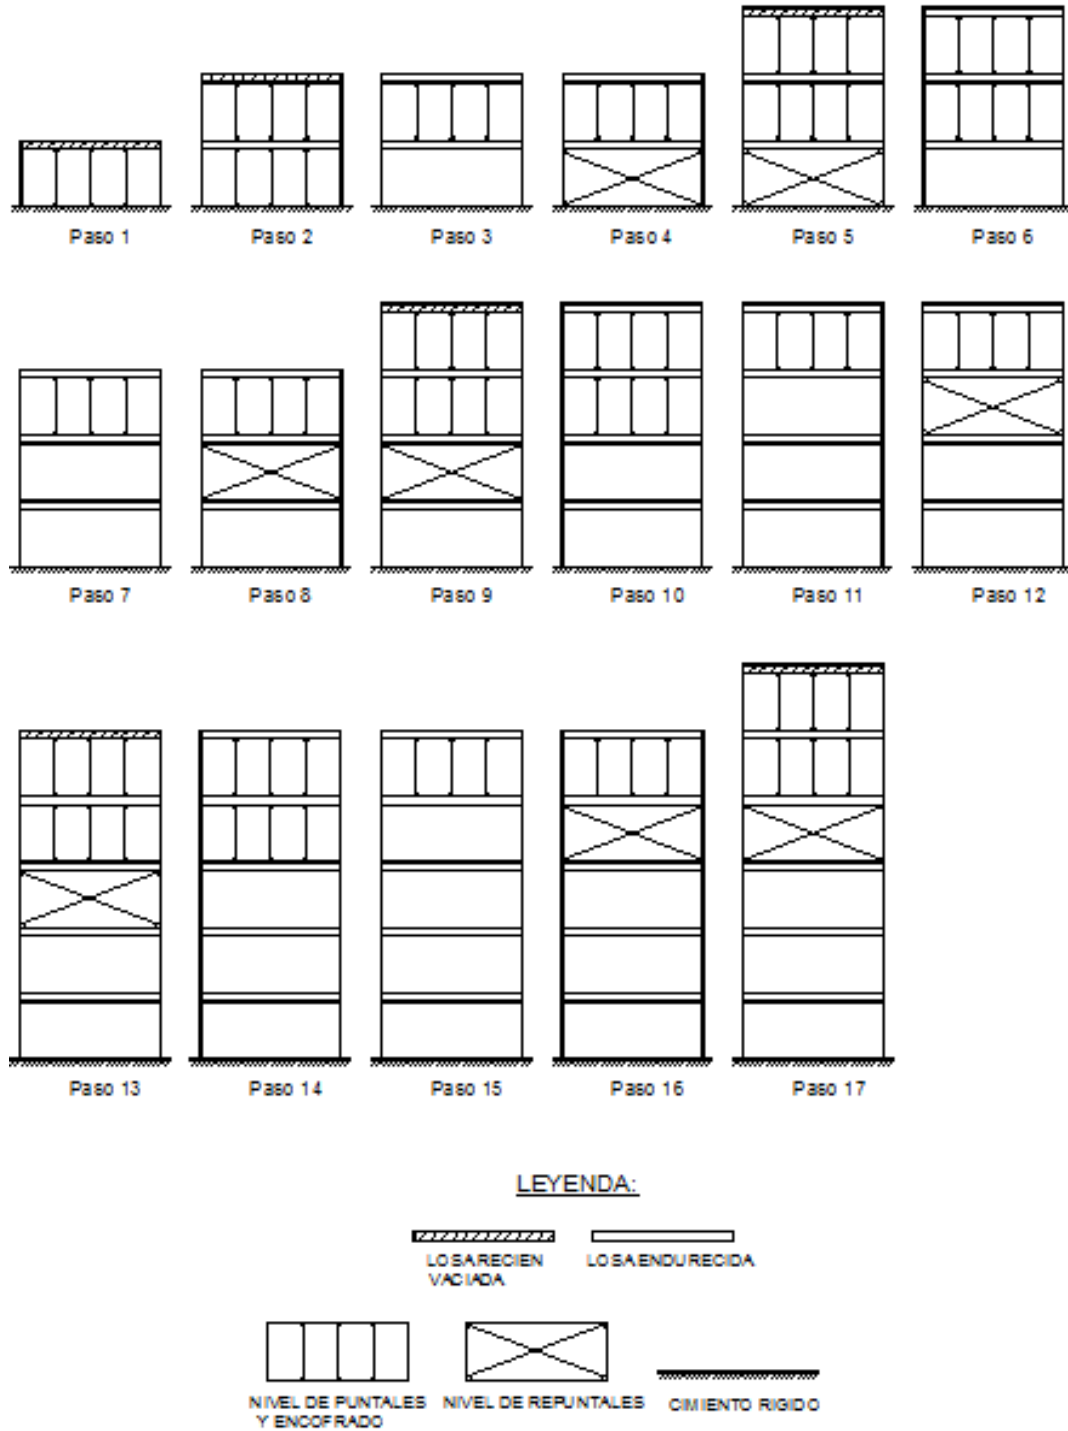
Sistema constructivo dos apuntalamientos y un reapuntamiento (2S+1R).
